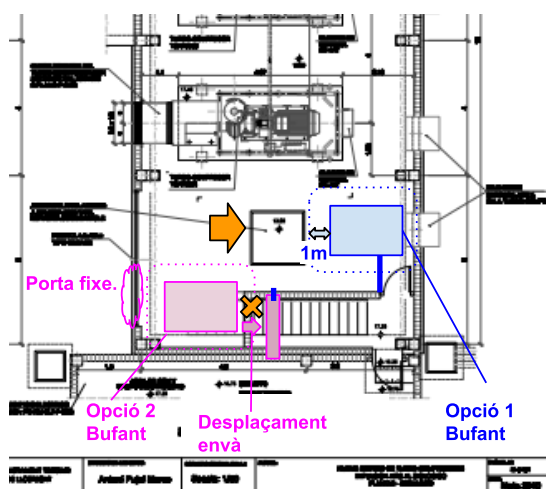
Detalle en planta de las opciones y área reservada instalación soplando, por su mantenimiento.
